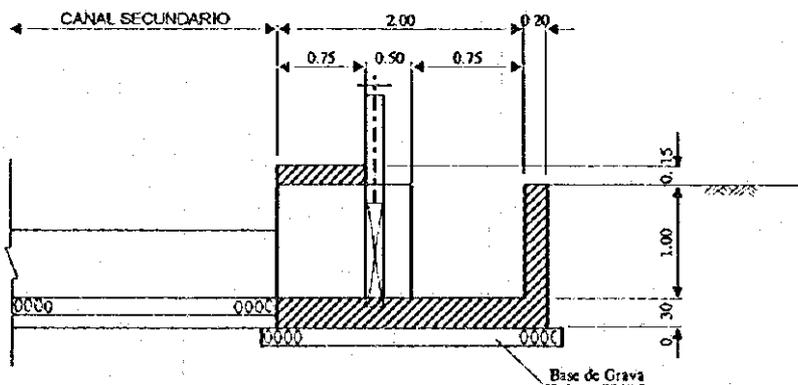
Plano de Sección Típica del Canal Principal de Riego
